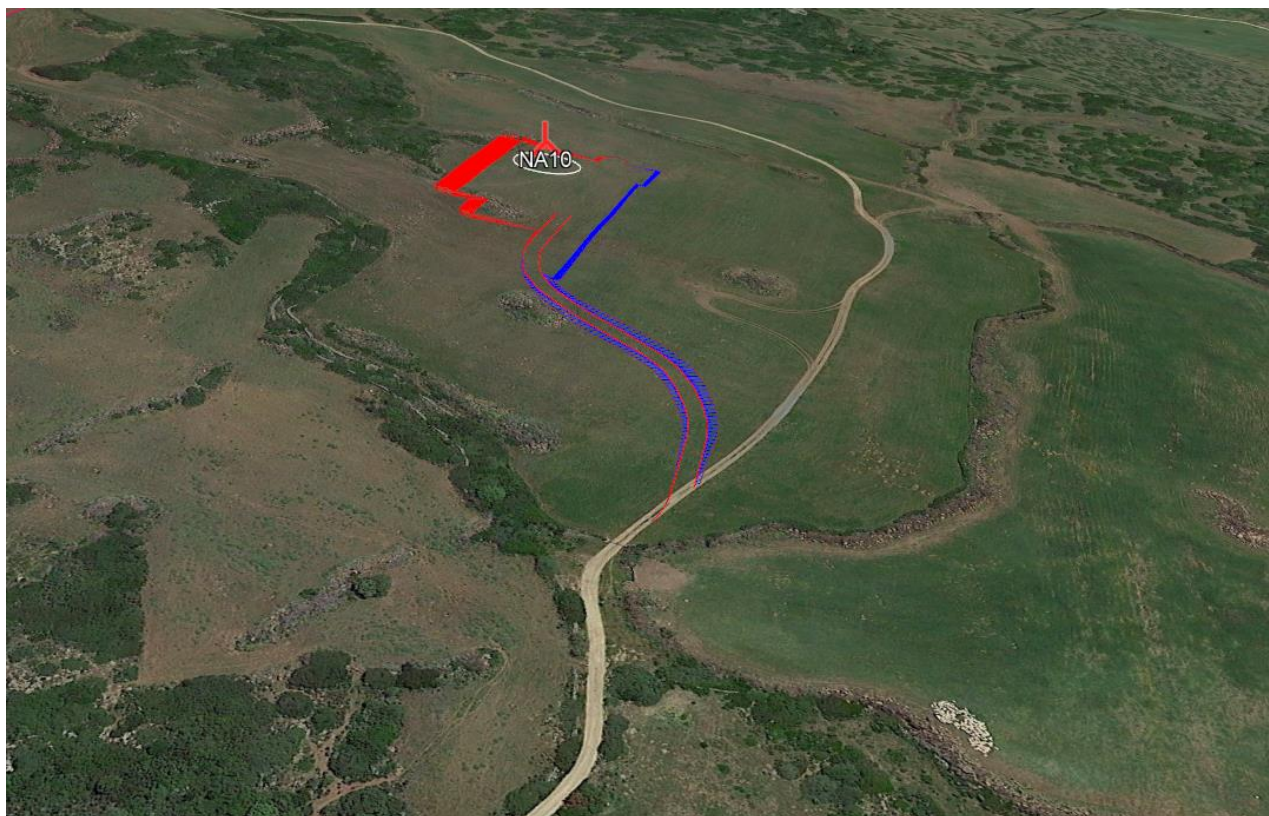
Asse di collegamento alla postazione eolica NA10 (vista aerea prospettica verso sud est)
